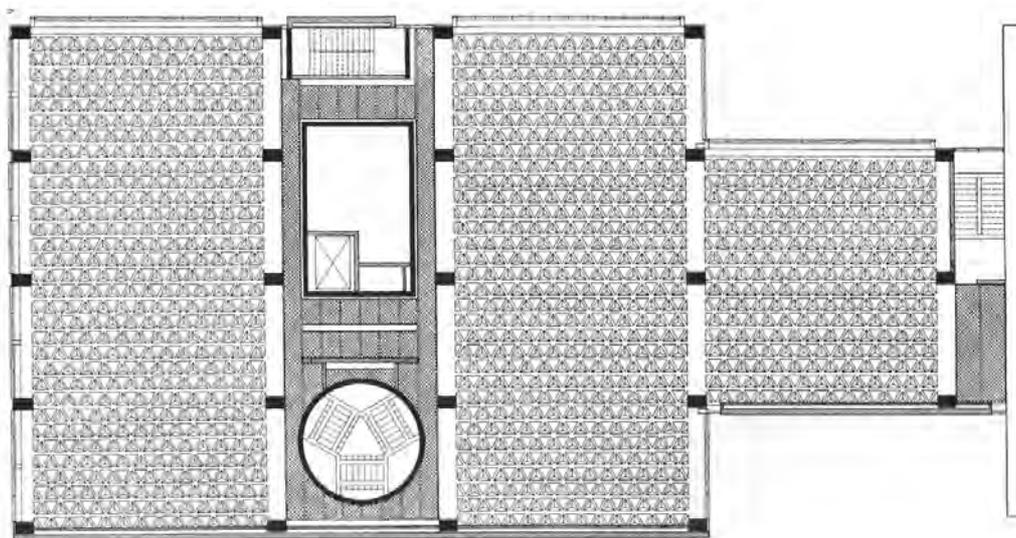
| Planta de forro da YUAG [GIURGOLA]
